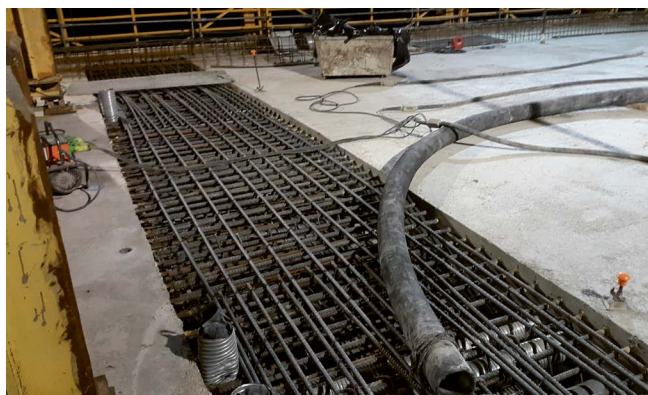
Hormigonado de dovela de cierre de tablero lado sur.
